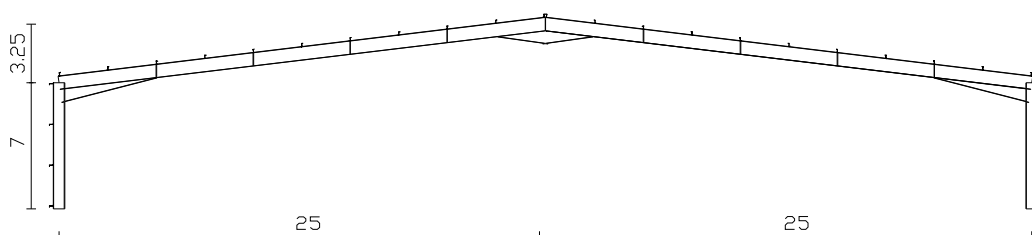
Pórtico rígido viga e pilar de alma cheia, vão de 50.00m com esquadros ligação pilar/viga, viga/viga
